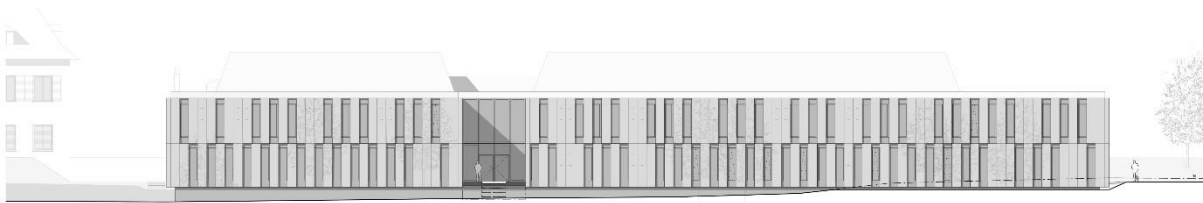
Fassade modulares Asylzentrum (Plan: Bauart)
